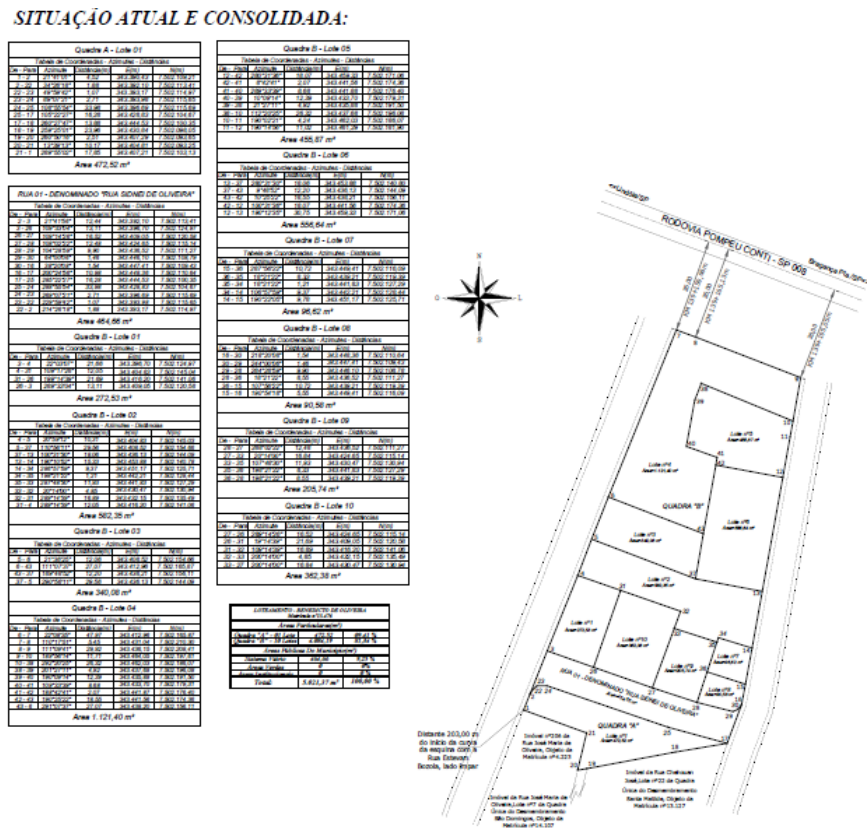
Planta da Situação Atual Consolidada (Fonte: Próprio Autor).
